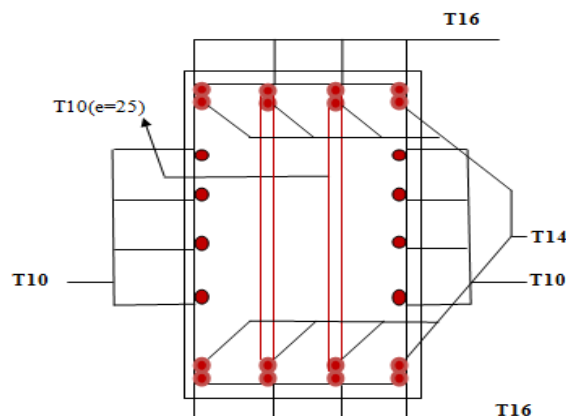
Plan de ferrailage de l'entretoise d'about
